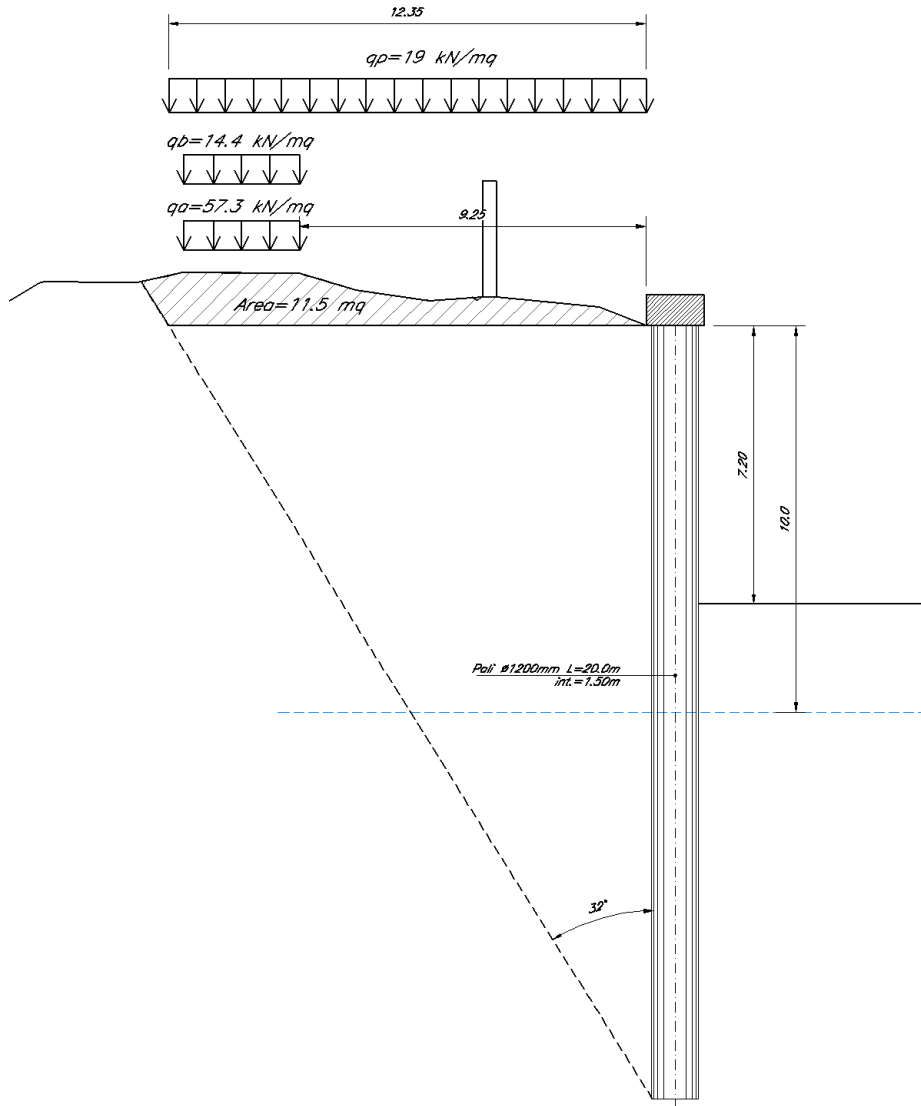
Spalla 2-sez.2: modello di calcolo
